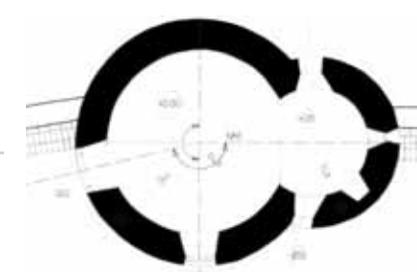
Grundriss Pottenstein, M 1:200. TU Wien, Planarchiv des BDA Wien.
